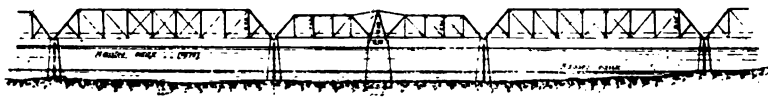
Pont en Bois et Fer sur la Colombie.
